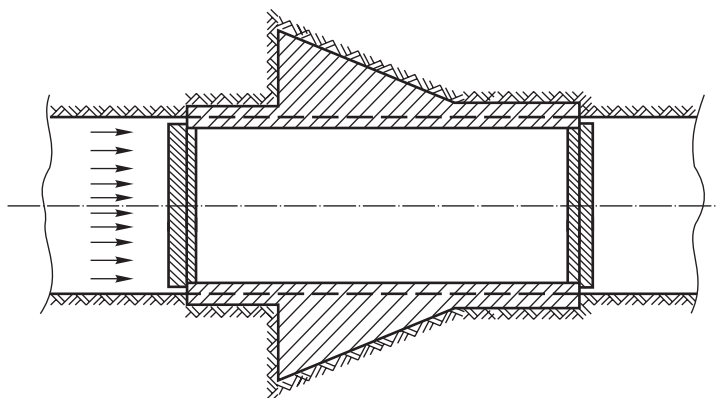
Безврубовая прямоугольная водонепроницаемая перегородка
